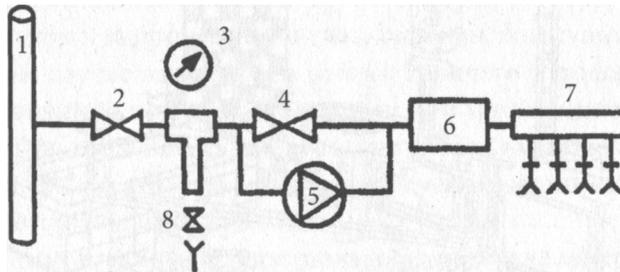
Схема подключения сантехприборов: 1 — стояк холодного или горячего водоснабжения; 2 — шаровый кран; 3 — фильтр грубой очистки воды; 4 — редуктор давления; 5 — насос (при его установке редуктор не ставится); 6 — счетчик расхода воды; 7 — коллектор; 8 — слив в канализацию
